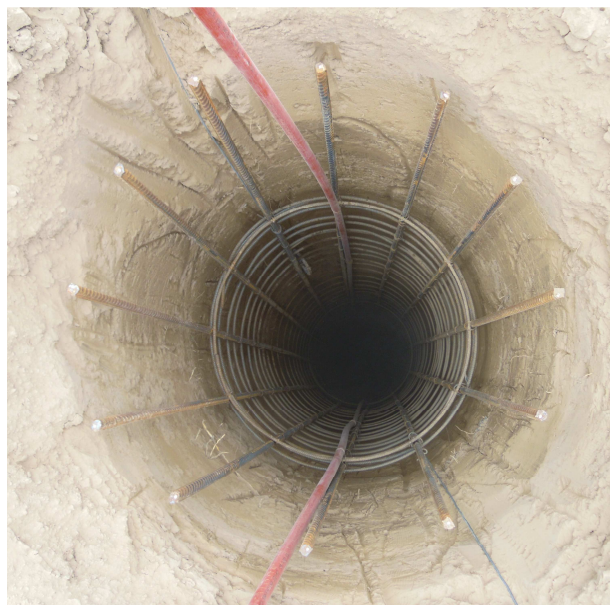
Armadura colocada en pozo – Fuente: Fotografía propia
